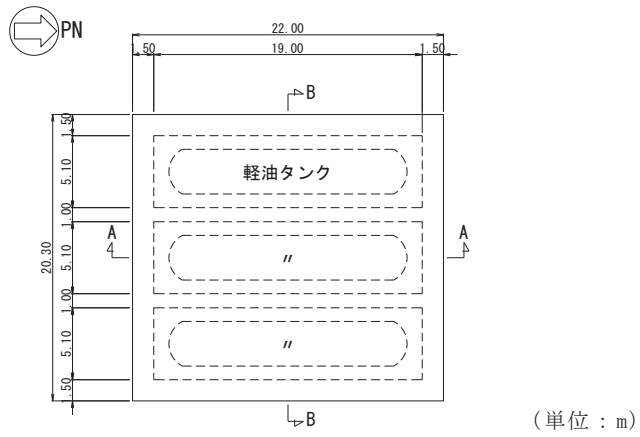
ガスタービン発電設備軽油タンク室平面図
